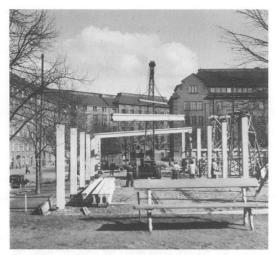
Aarne Ervi. Construcción del prototipo desarrollado con elementos prefabricados de hormigón armado, 1955 (Johansson, Lahti y Paatero 2010)
